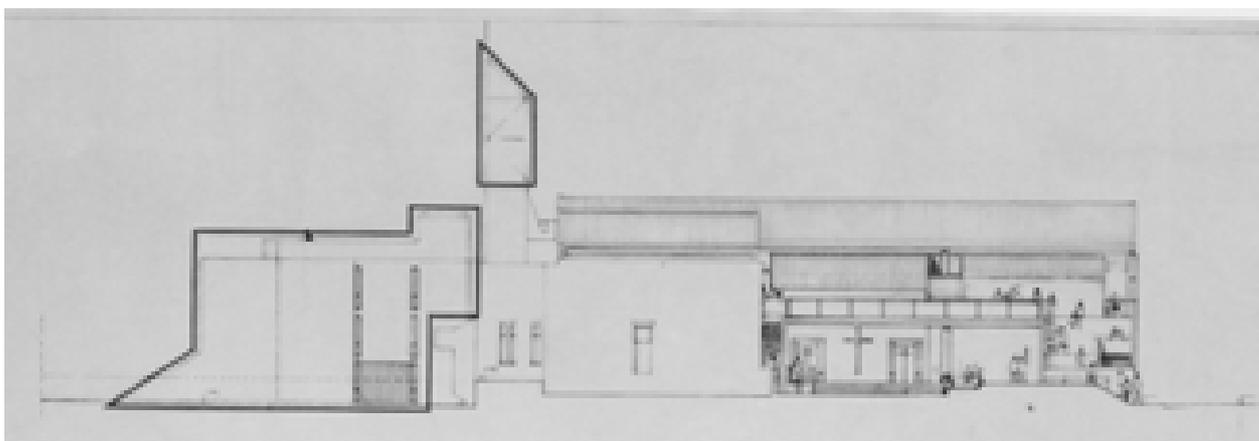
Prospetto Est, stato futuro –09/12/1997 (AABS-1996.1018)
